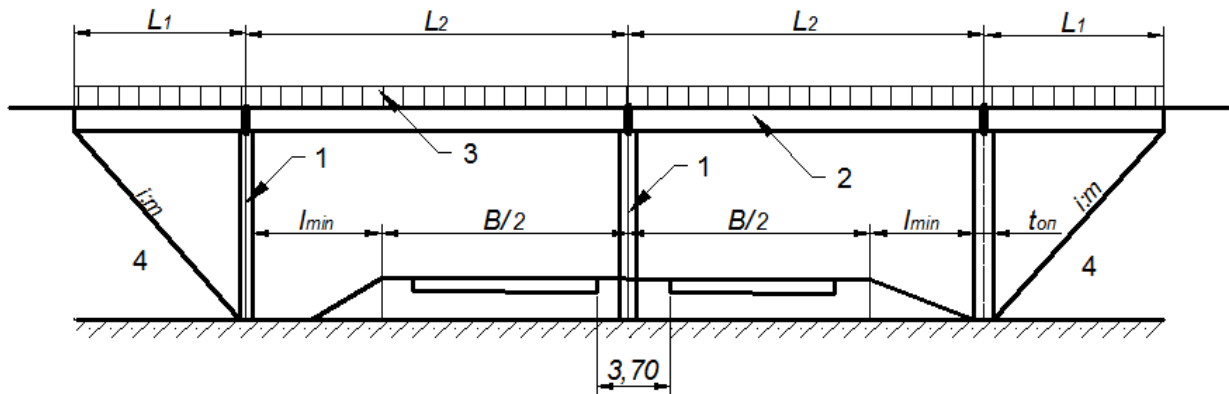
Схема четырехпролетного балочного путепровода: 1 – опора; 2 – пролетное строение; 3 – перила; 4 – конус насыпи.
